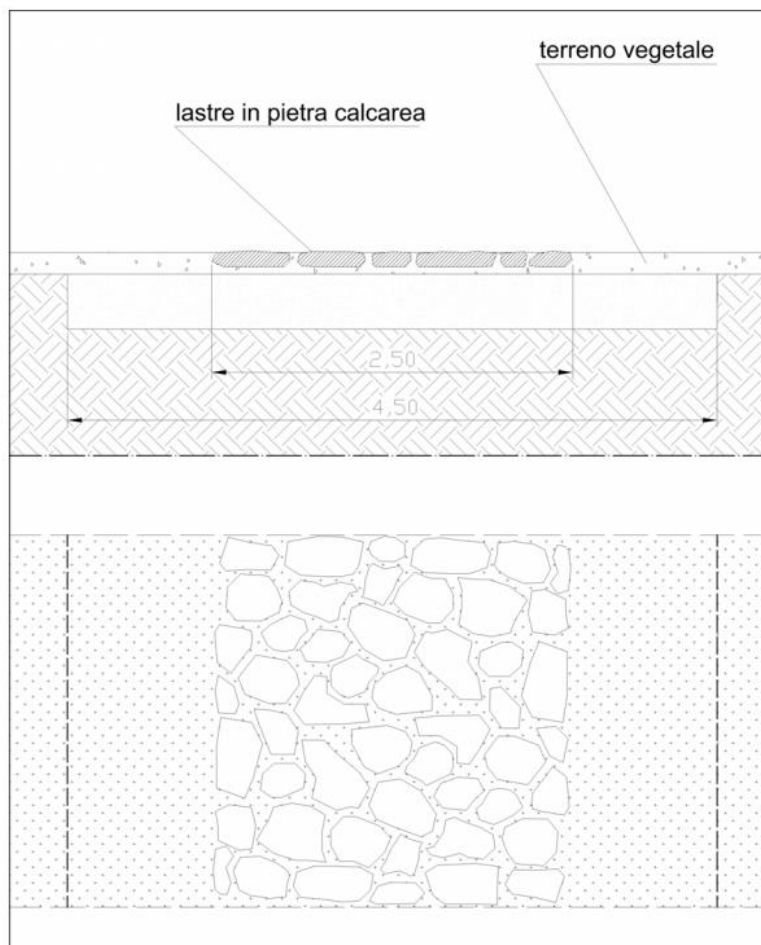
Ricostruzione della cotica erbosa sopra la sede stradale
